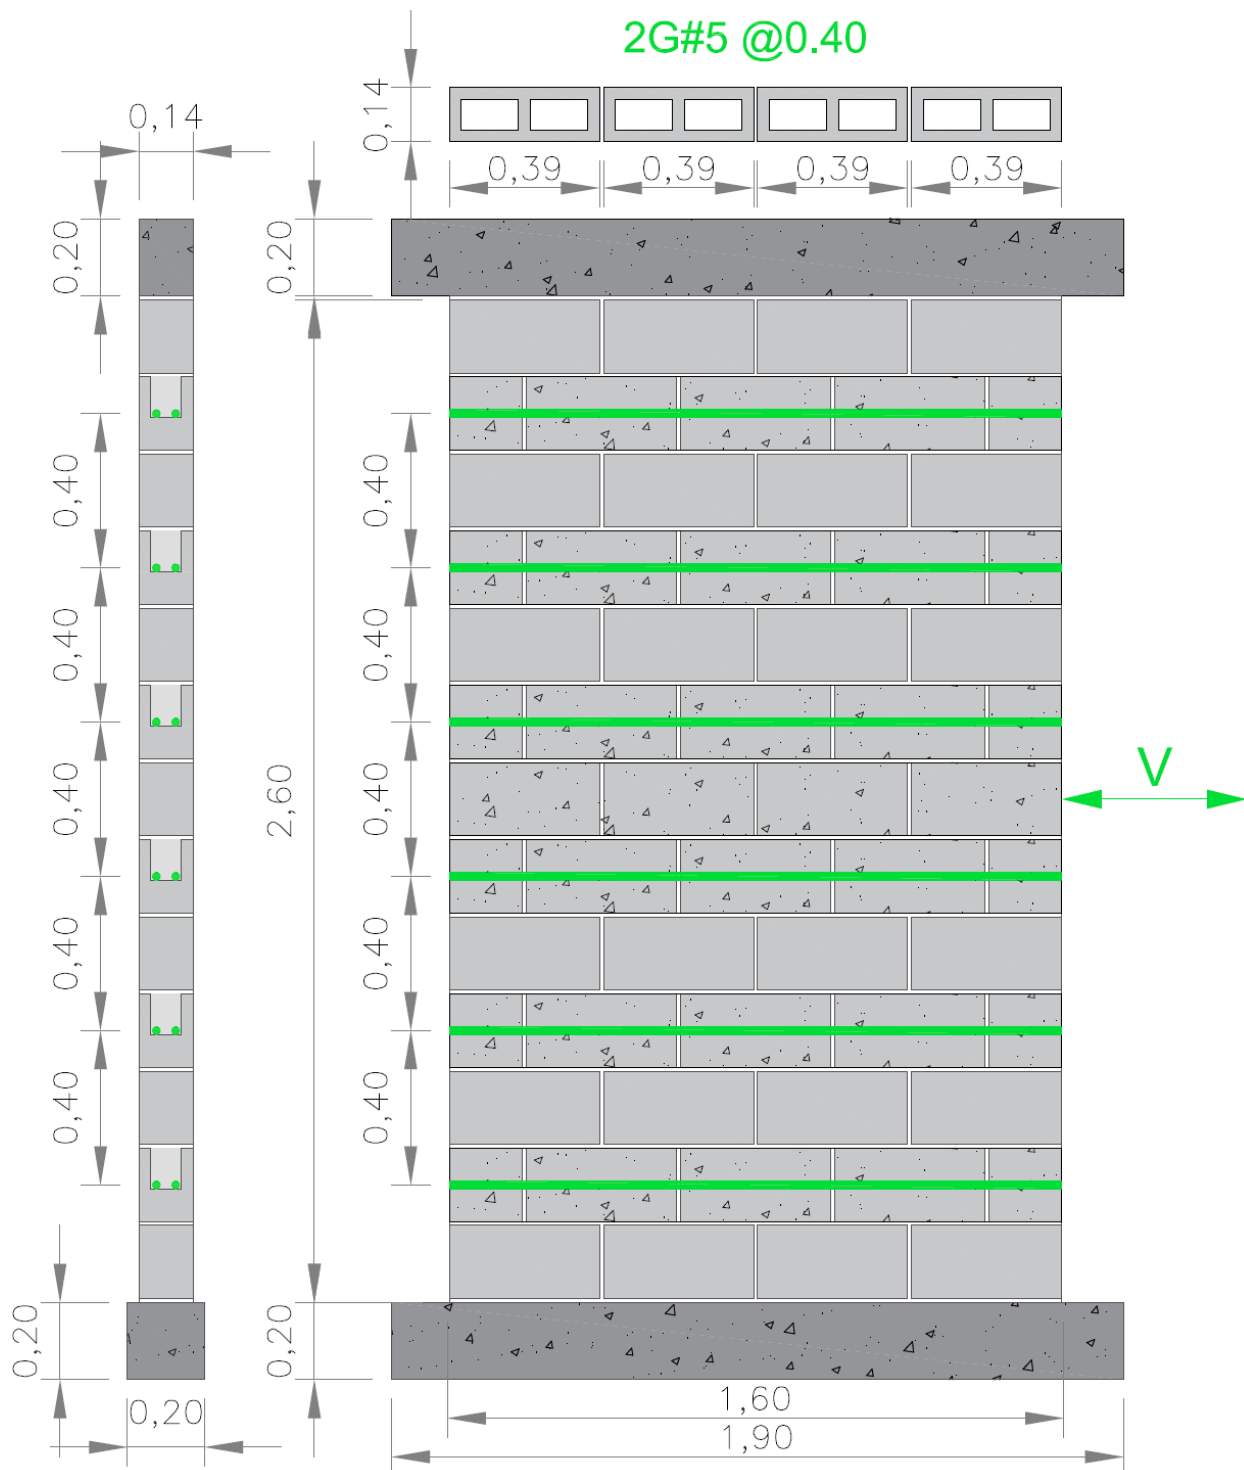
Configuración del refuerzo del muro MC-2#5/40
